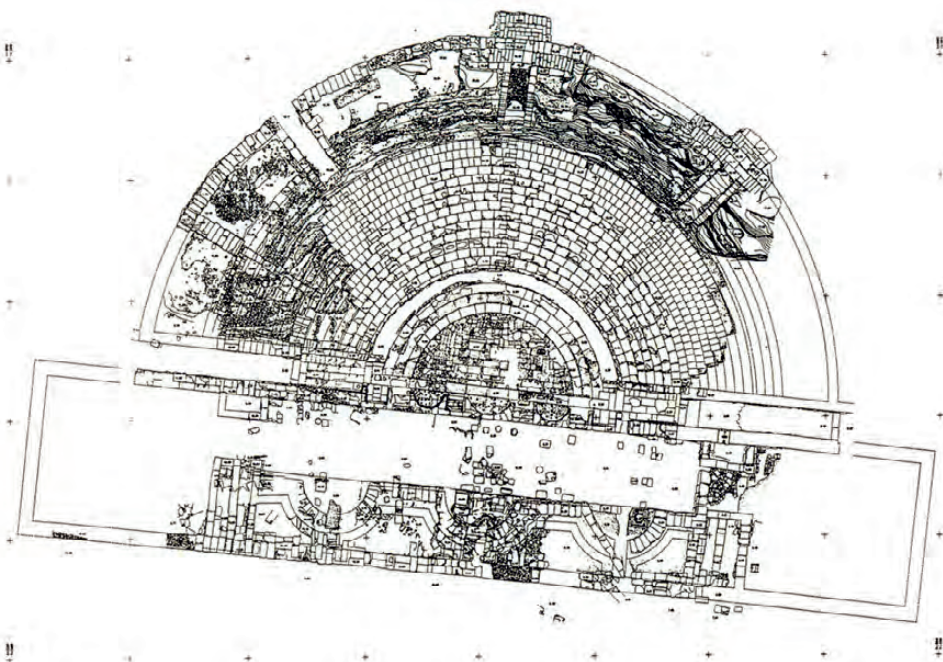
Planta actual de las estructuras conocidas del teatro romano.
